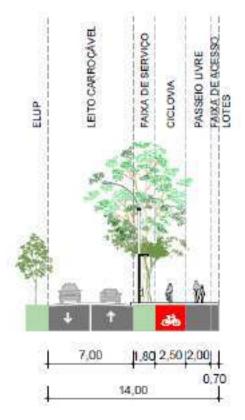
Corte Esquemático 13 – Vias de Circulação de Vizinhança 1
